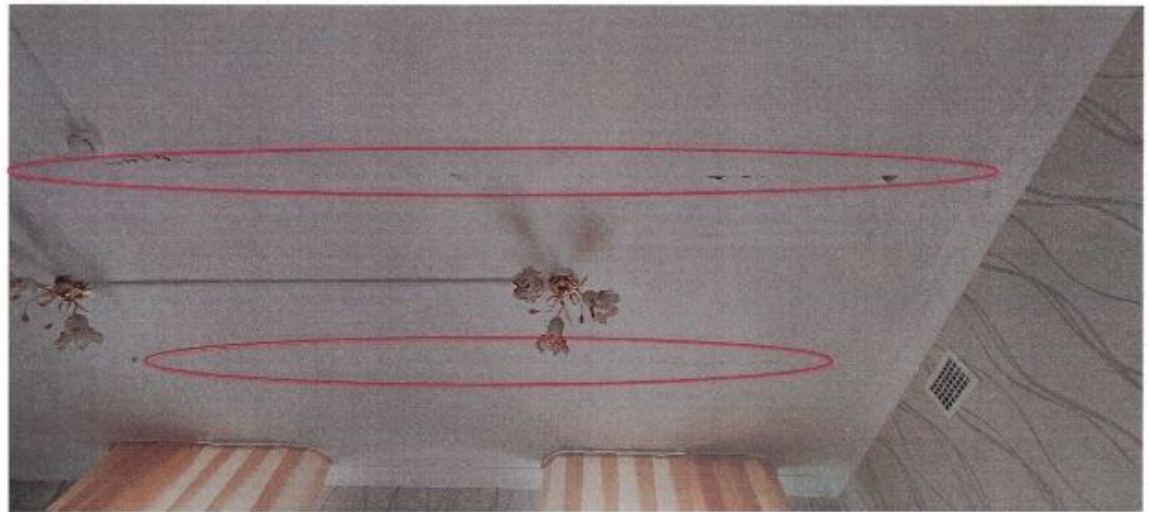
Трещины и отслоение межплитных швов перекрытия
